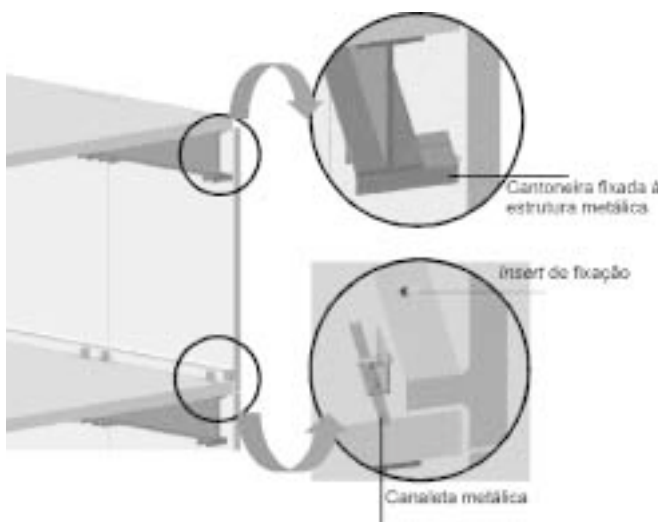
Detalhe do sistema de fixação na base do painel de concreto.
